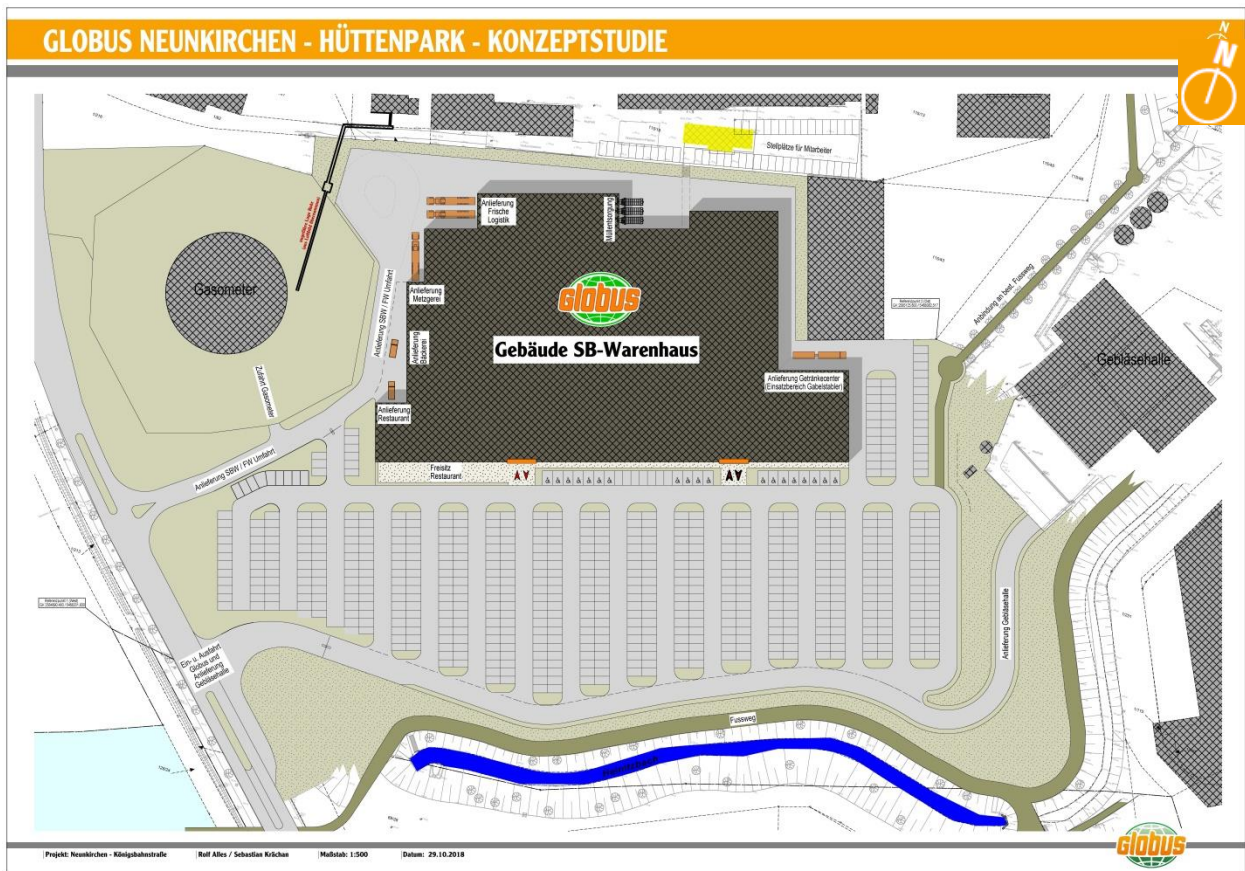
Lageplan, geplantes SB-Warenhaus im Hüttenpark (nicht maßstäblich, Stand 09. April 2018)
